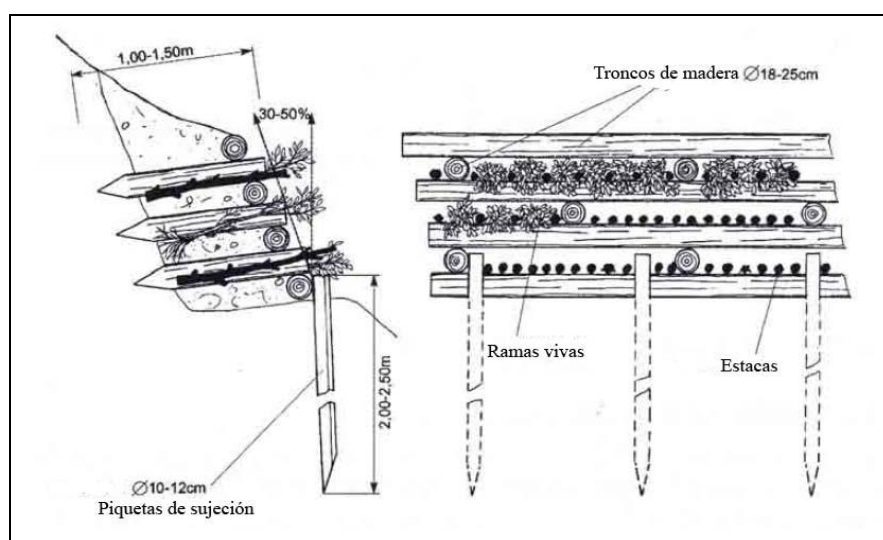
Perfil y alzado de entramado a una pared en ladera. Fuente: Florineth, 2010.
